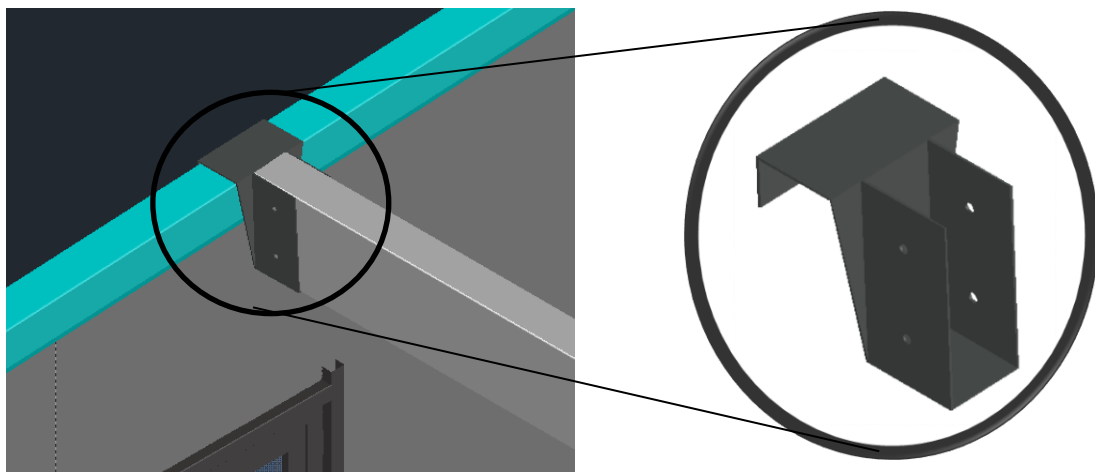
Detalle de la pieza de soporte de la viga en tramo recto inclinado.
